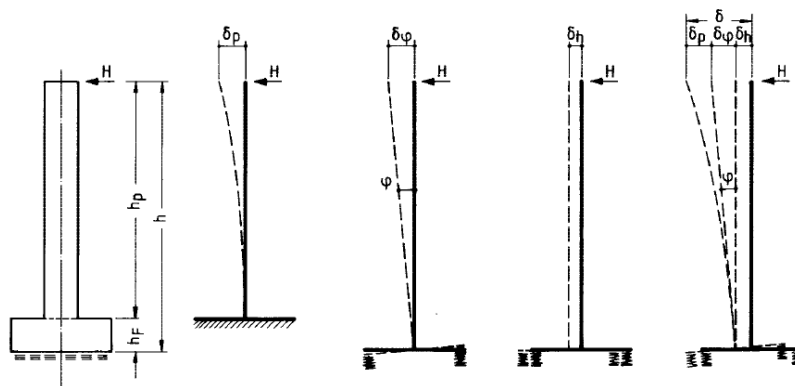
Rigidité longitudinale équivalente sur la structure d'appui
